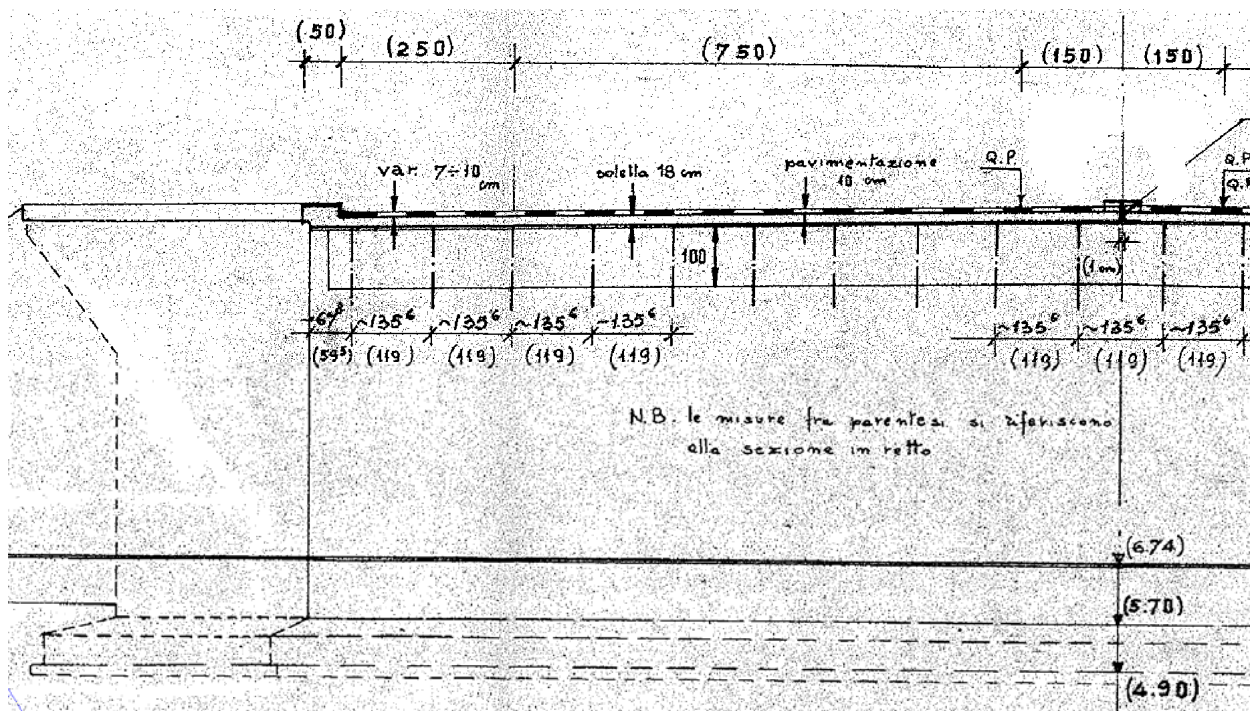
Semi-prospetto spalla esistente
